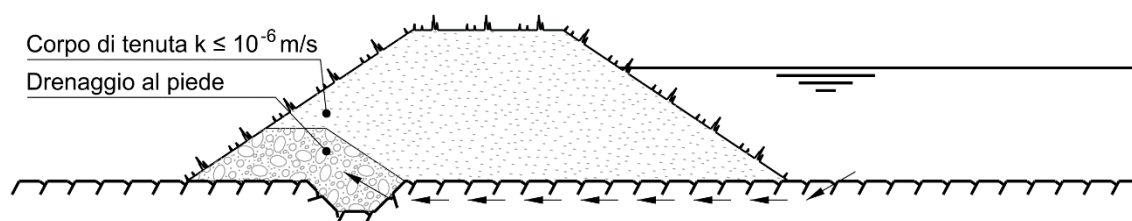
Argine di protezione dalle piene con drenaggio al piede e strati di scorrimento sottostanti
